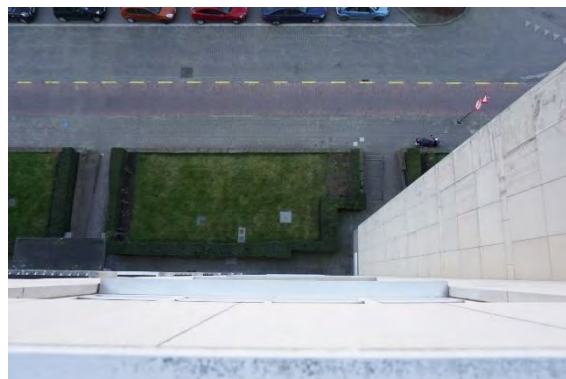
Achtertuinstrook gezien richting Olivetenstraat, met garageboxen
